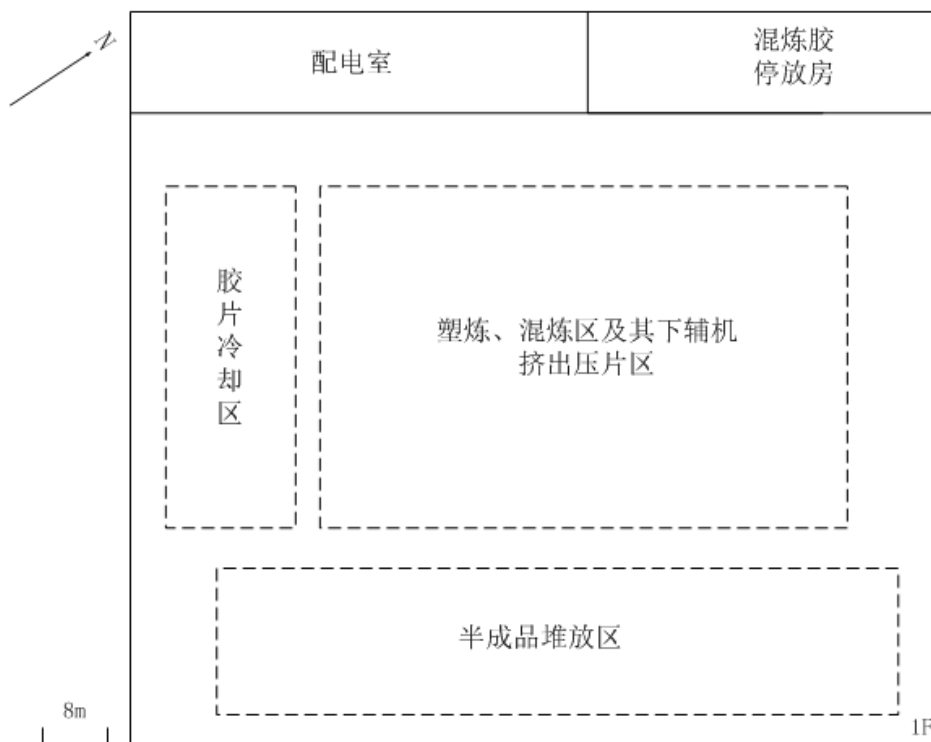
项目炼胶车间 1F 平面布置（变动前）
